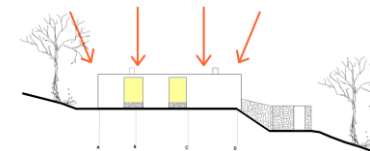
Ingreso de luz por la fachada Oeste. Fuente: Autor.
